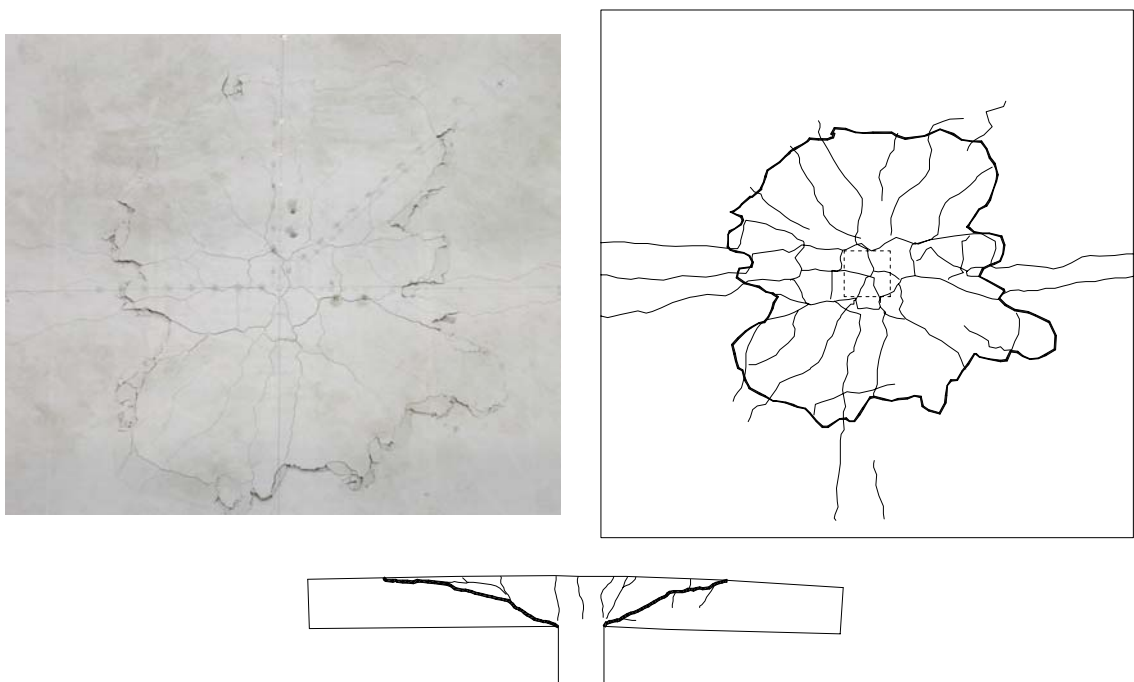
PG-5 : Fissures face supérieure (N en haut) et coupe NS
